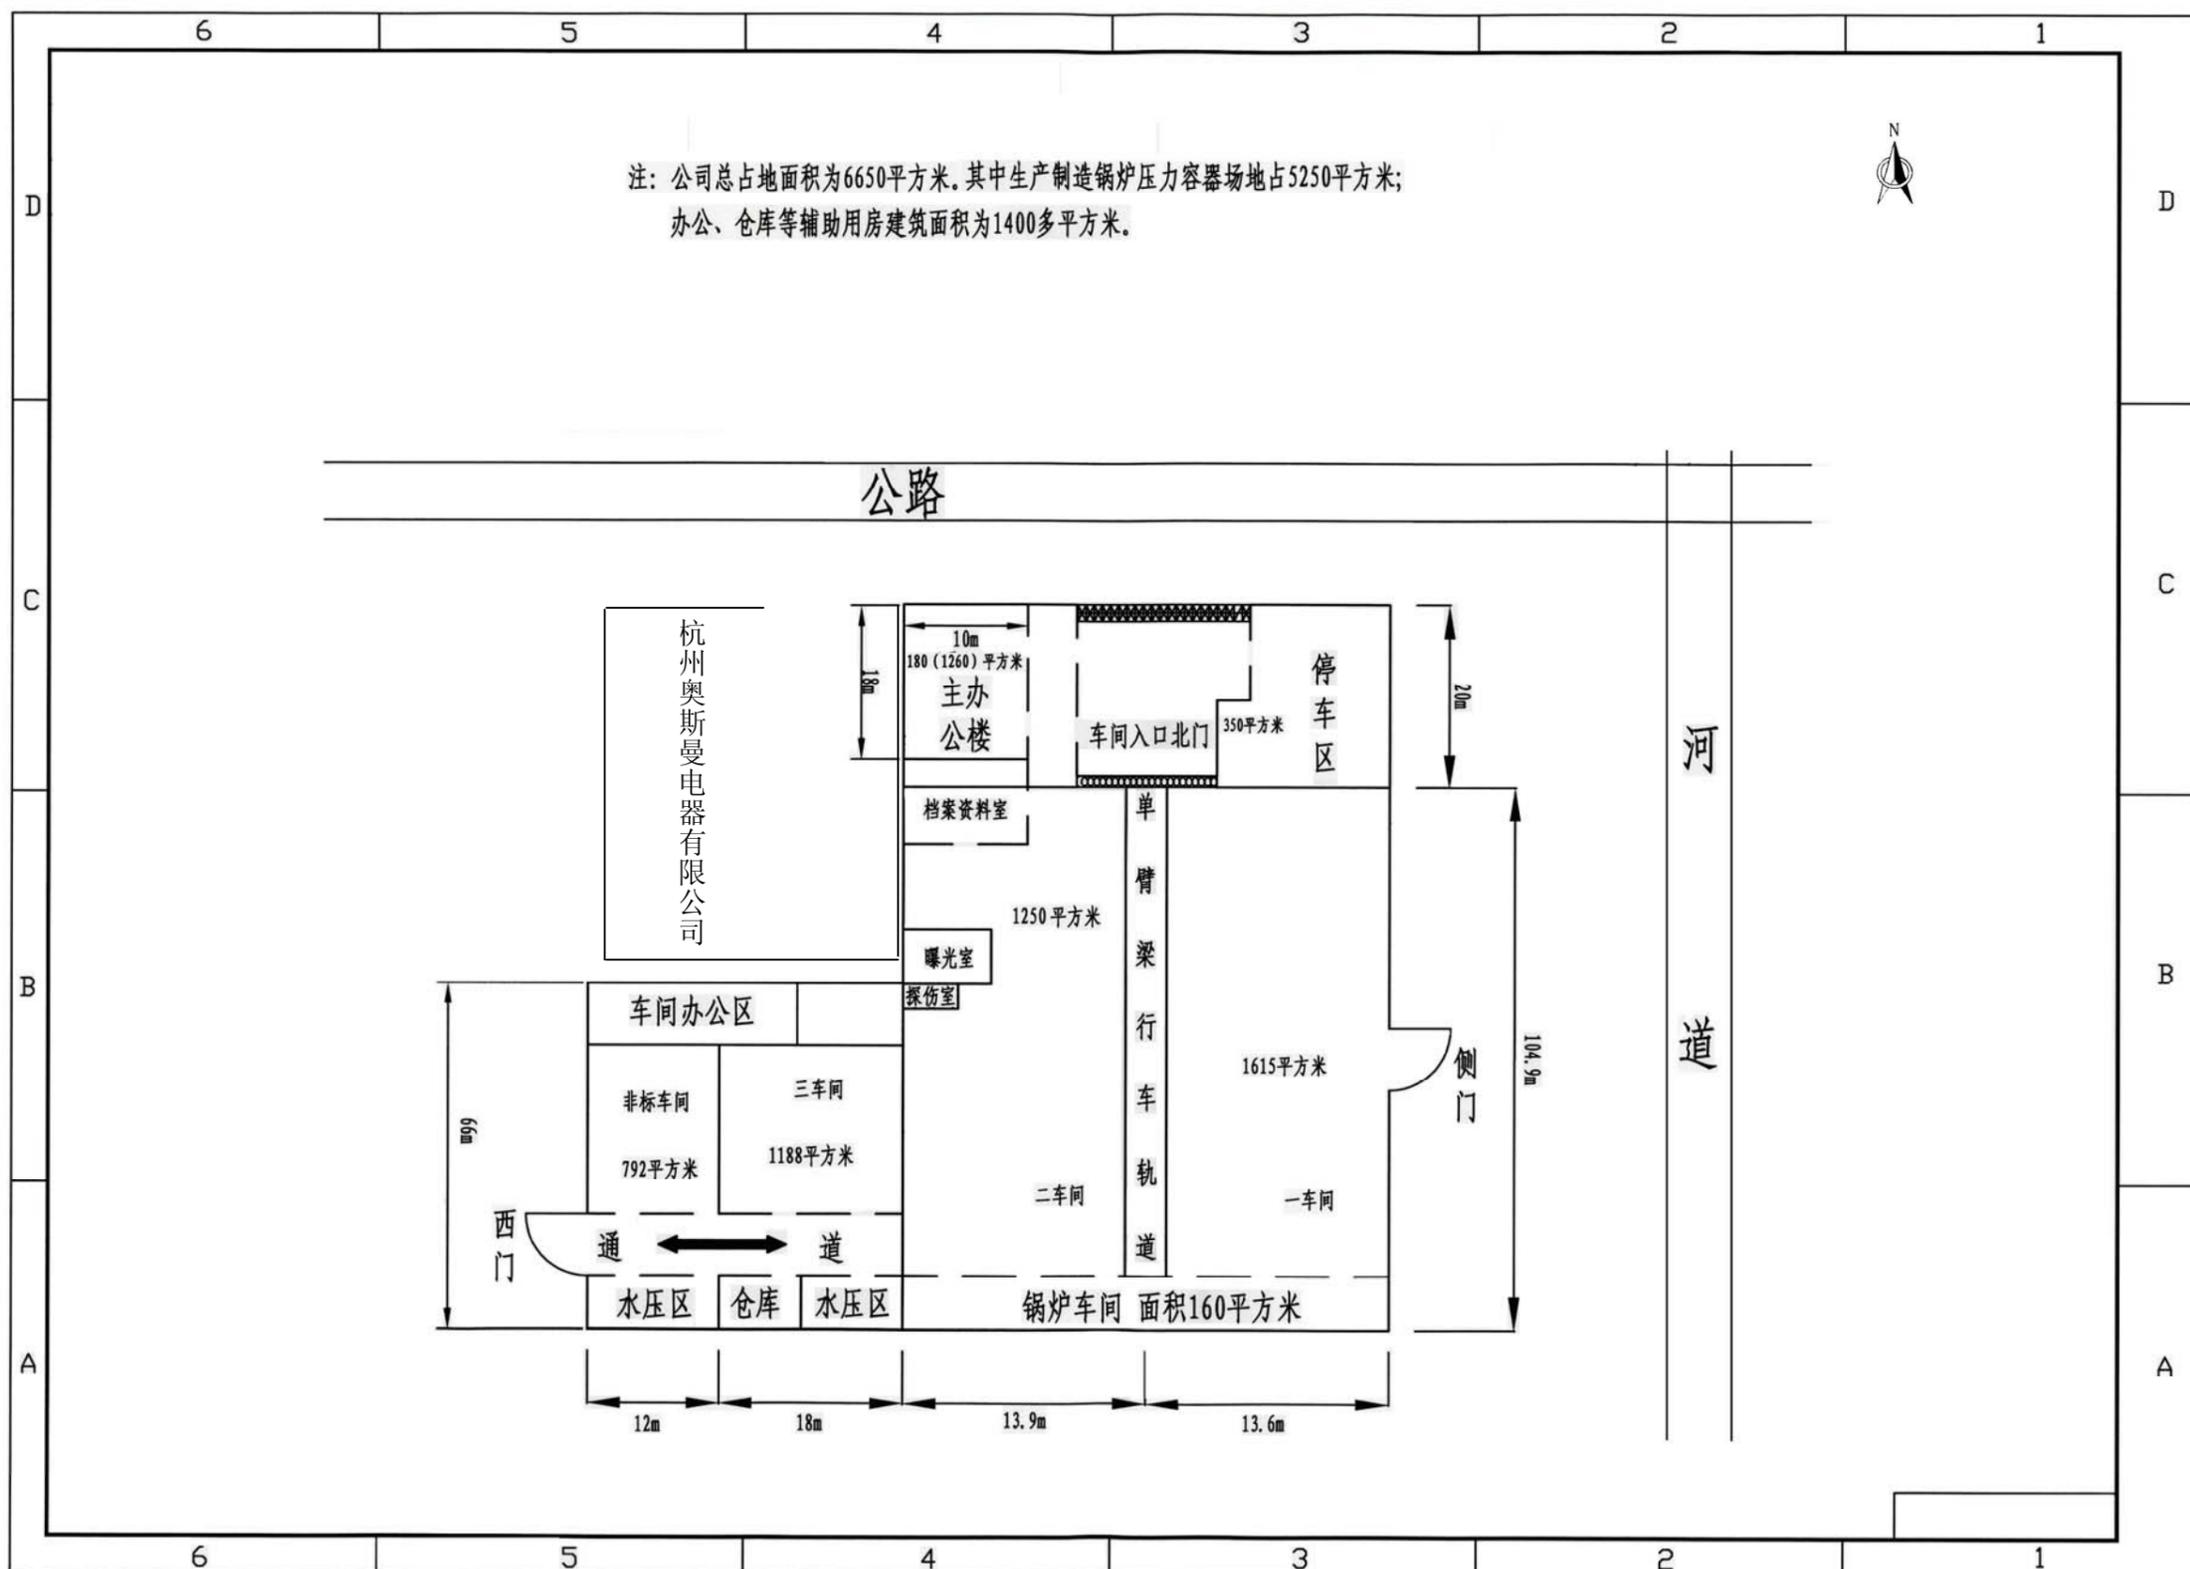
杭州荣达锅炉容器有限公司生产车间总平面布置示意图
